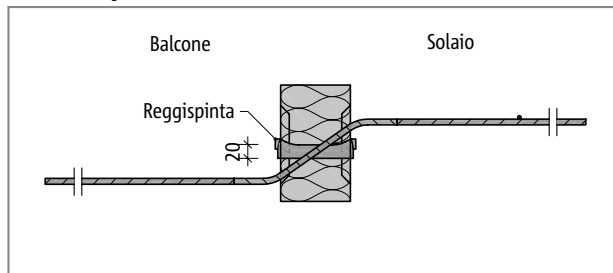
Schöck Isokorb® tipo QXT60 – QXT90: sezione dell'elemento
